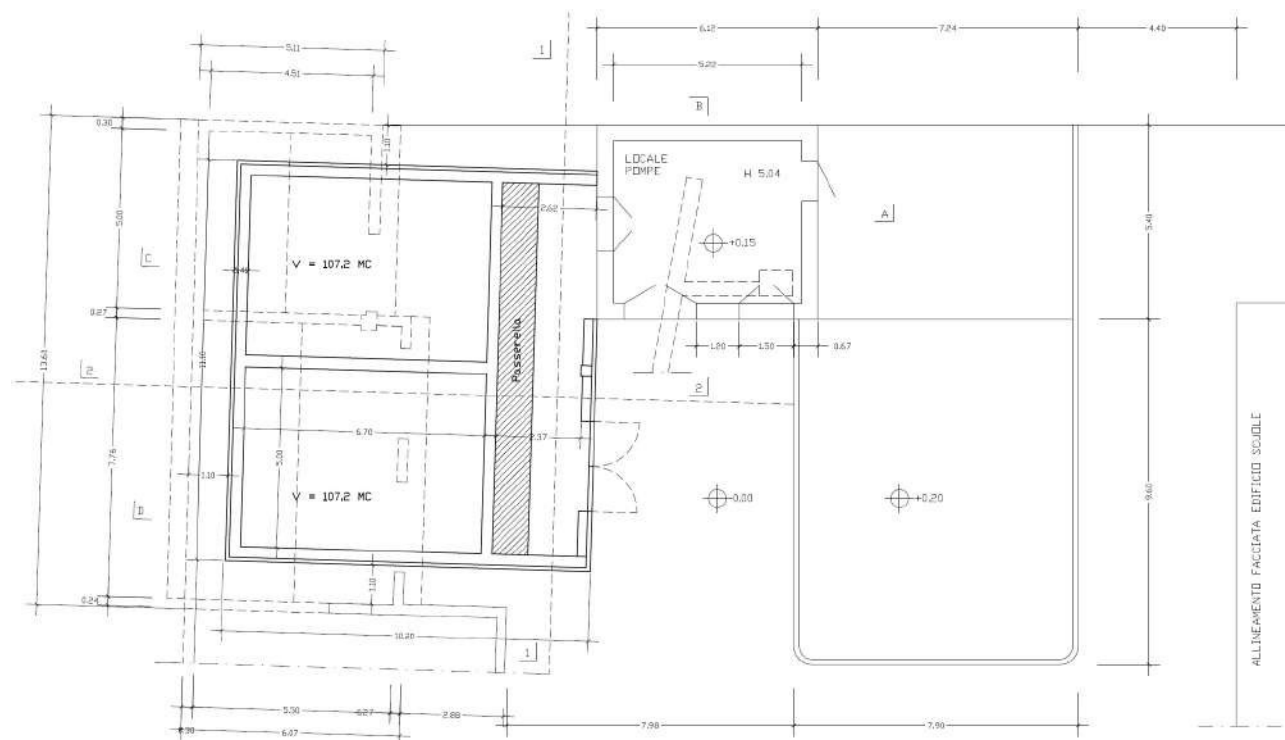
Planimetria indicativa dell'intervento in previsione
